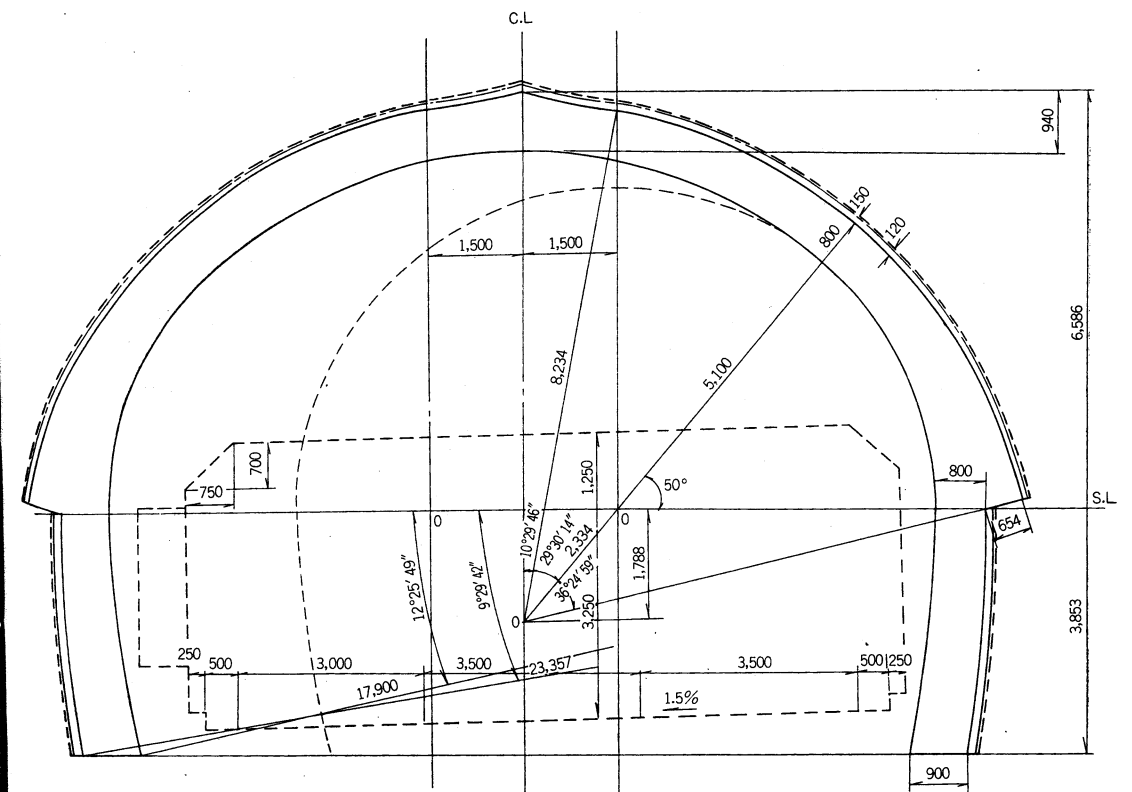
非常駐車帯区間標準断面図 (Mタイプ)
